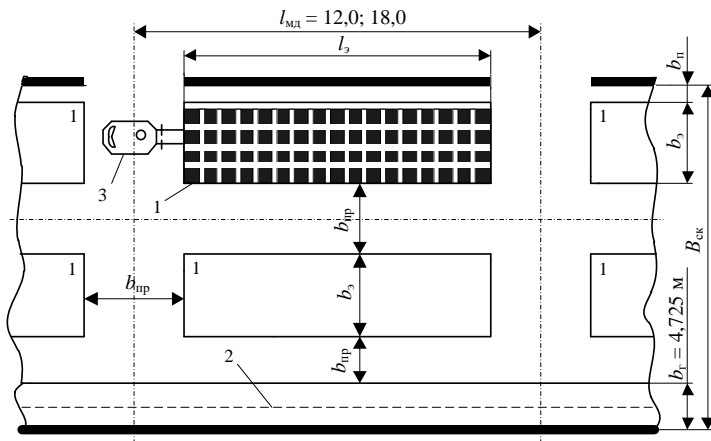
Схема к расчету параметров элементарной площадки:
